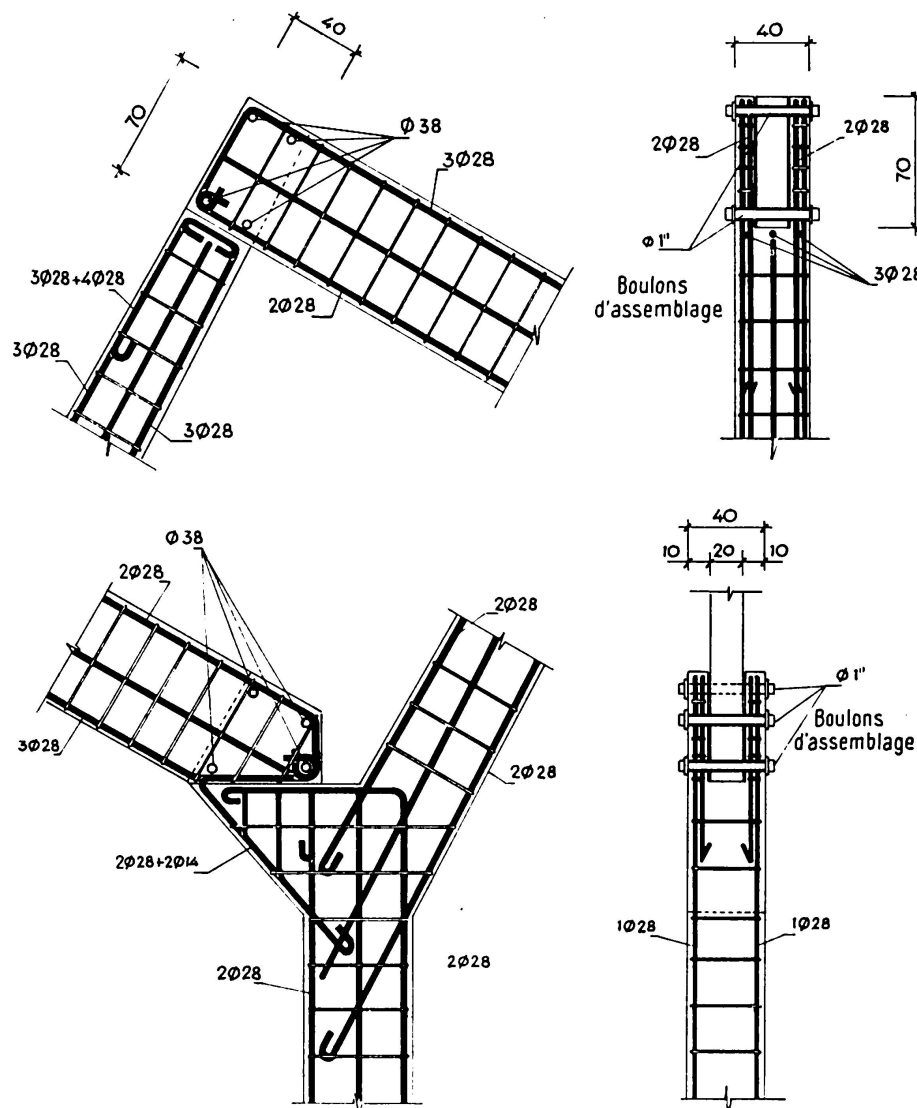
Système d'assemblage entre poutre inclinée et montant.
